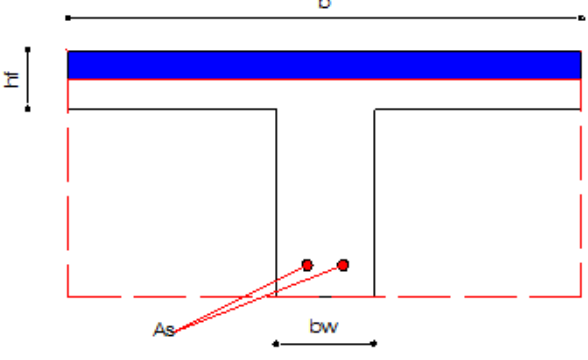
Refuerzo longitudinal para la vigueta (cm²)
